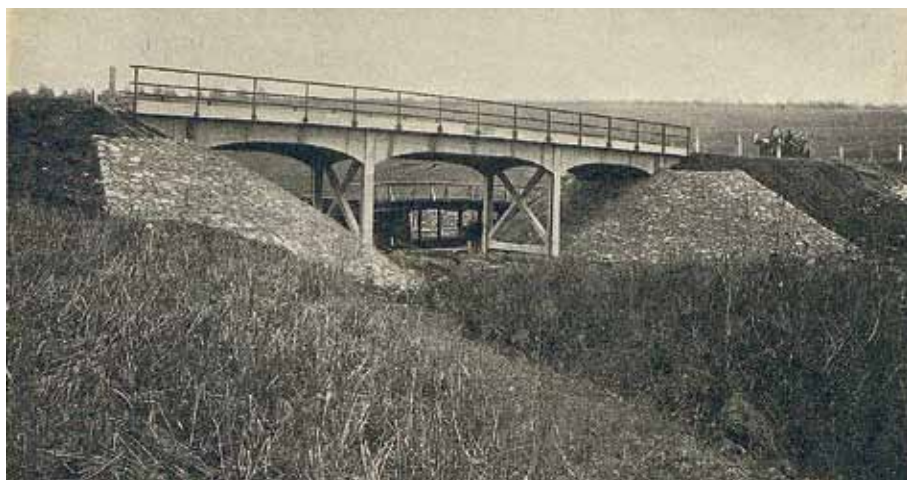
Земский железобетонный мост у села Тепловка Саратовского уезда
